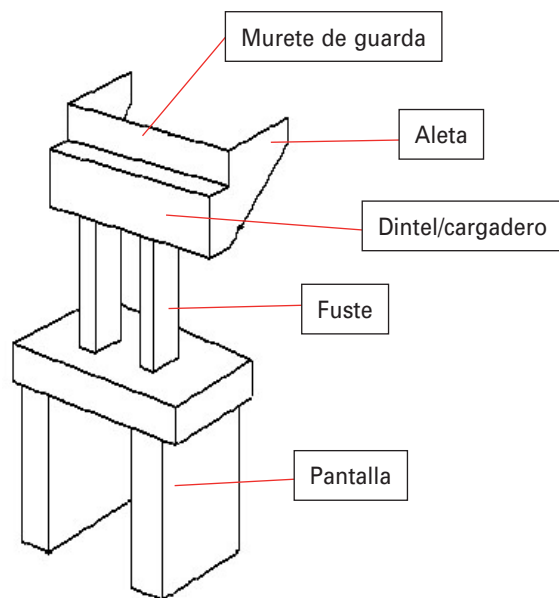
ELEMENTOS EN UN ESTRIBO.
